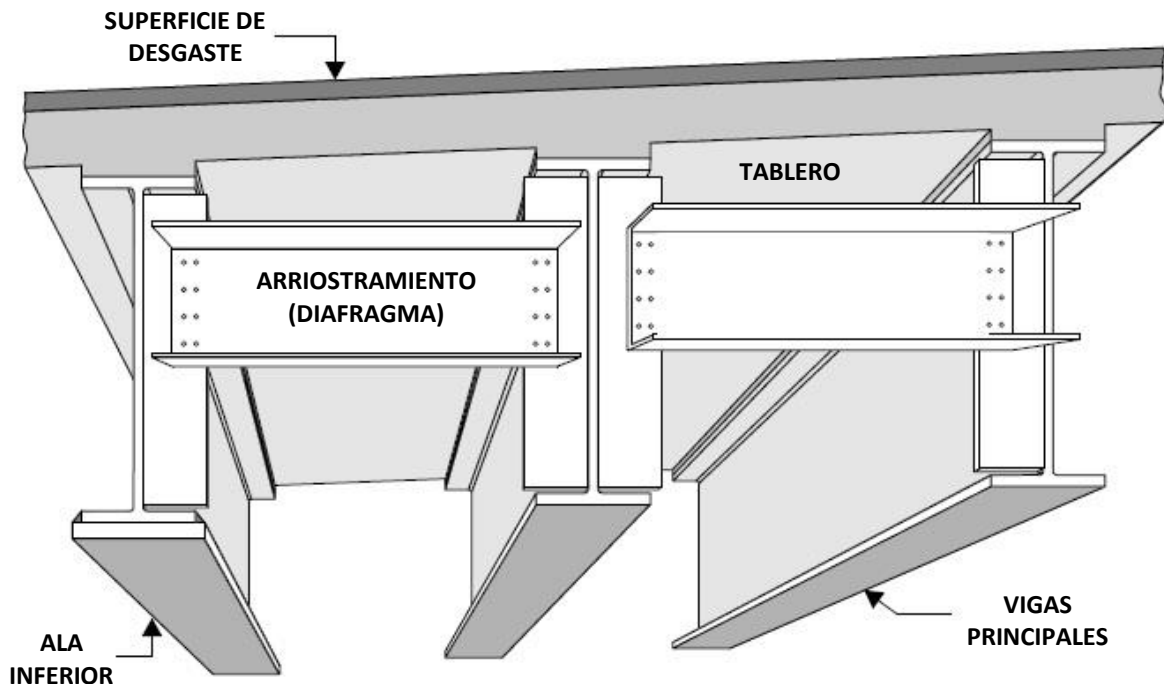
Componentes principales de una superestructura de losa sobre vigas (Tonias, 1995)
